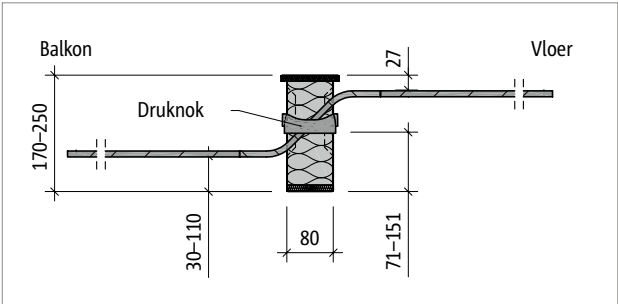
Schöck Isokorf® T type Q-E-VV5: Zijaanzicht
